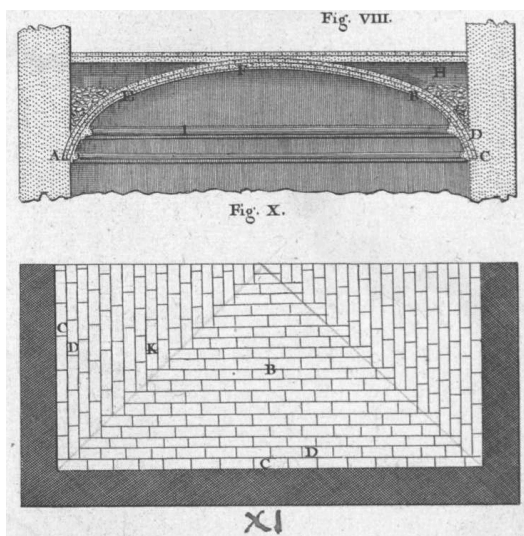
Voûte assez surbaissée en brique, extrait de la planche LXXXXV du cours de Blondel et Patte (1777b)
